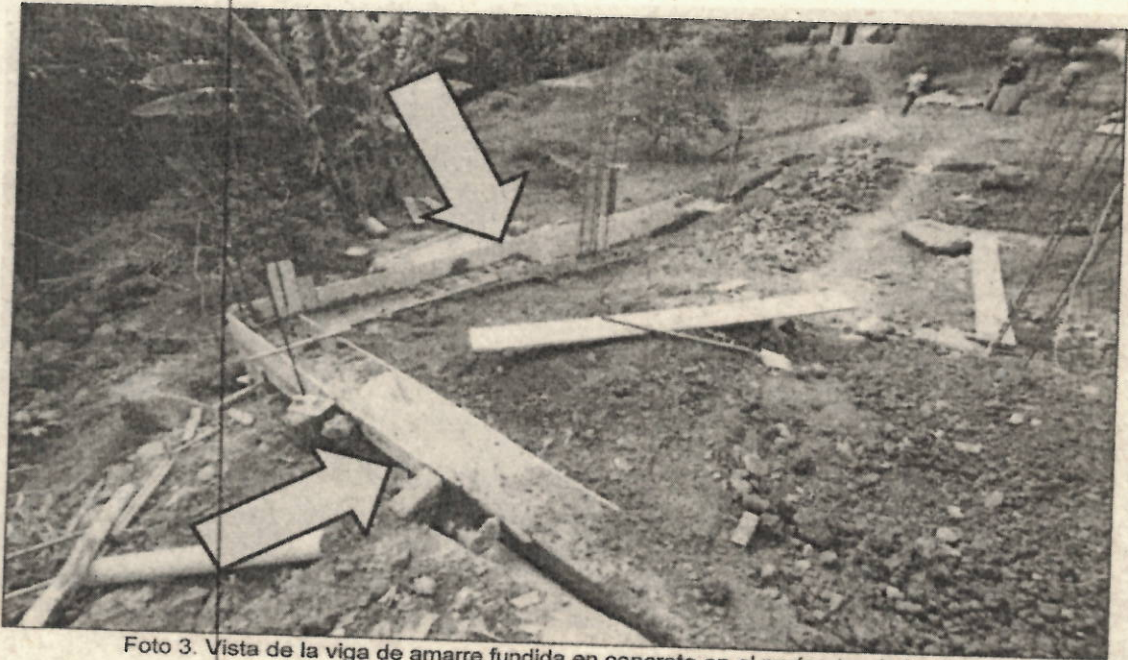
Vista de la viga de amarre fundida en concreto en el perímetro de la obra.
